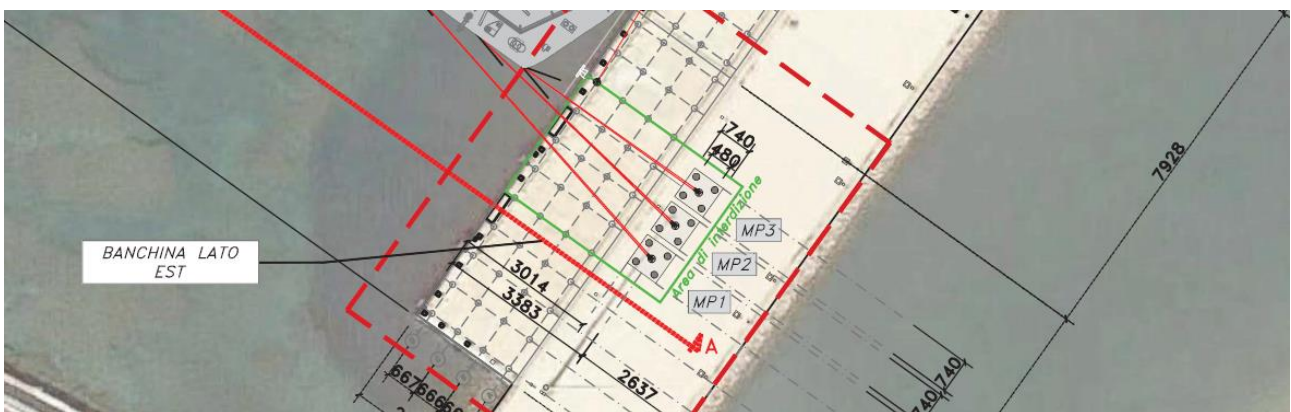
Layout dei plinti del sistema di rinforzo fender
